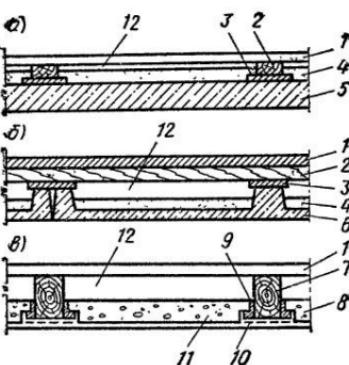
Доштатые полы с звуко- и теплоизоляцией междуэтажных перекрытий
